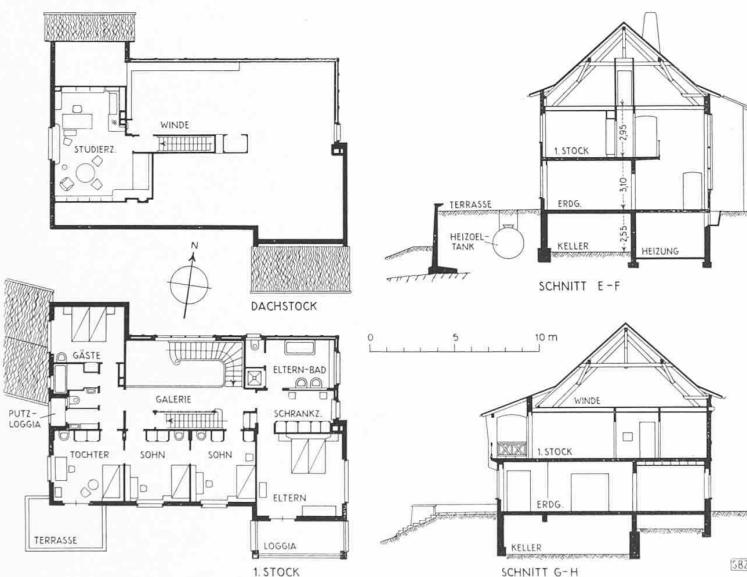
Grundrisse und Schnitte 1:400
